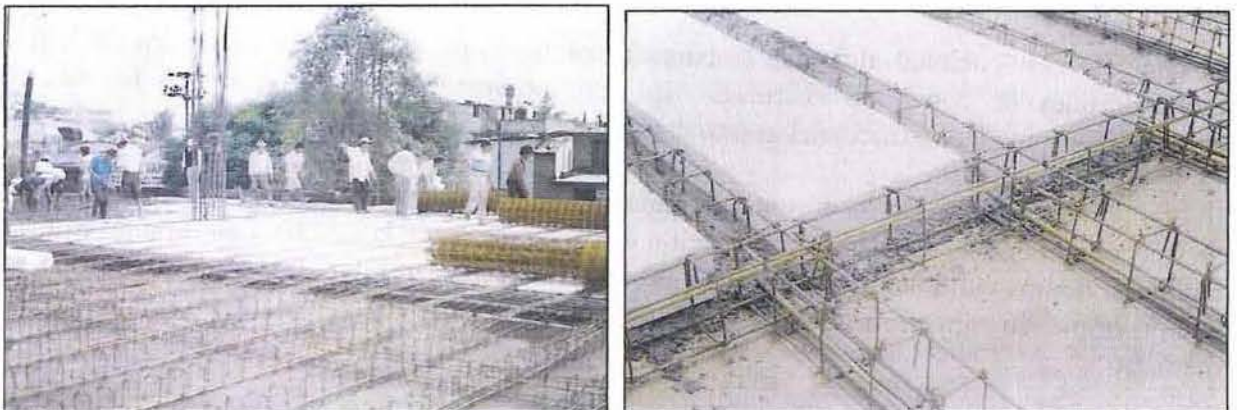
Izquierda, colado con concreto de las traves y losa de los pisos. Derecha, Colado de la capa de revestimiento inferior del poliestireno y torón de preesfuerzo en las nervaduras transversales.
